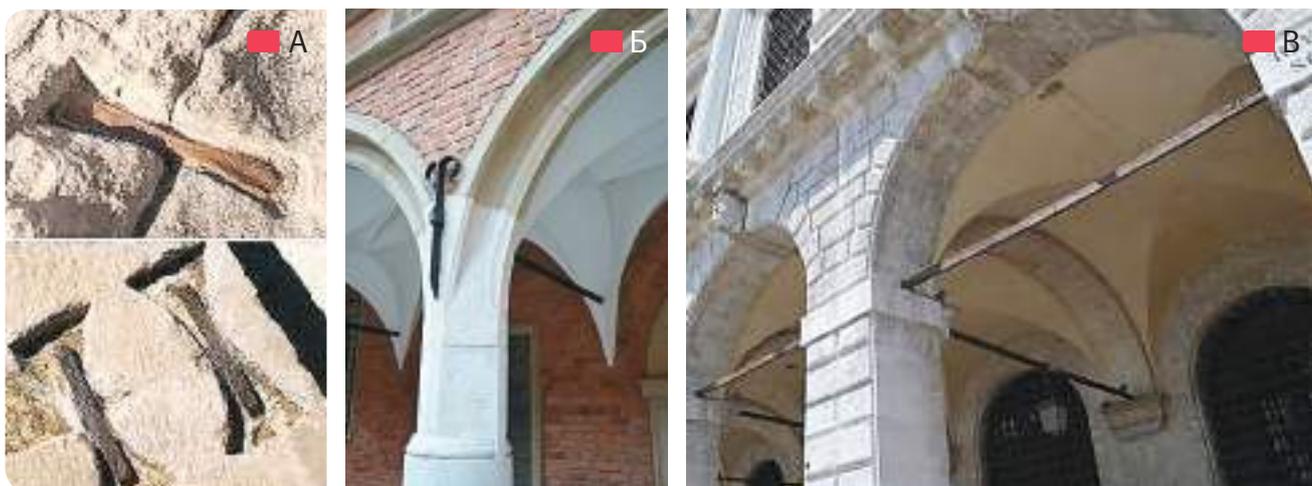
А – металлическое скрепление кладки в древнем Египте и Иране; Б – анкеровка стены собора в Кракове, Польша; В – железные затяжки каменных колонн во Дворце Дожей в Венеции, Италия
